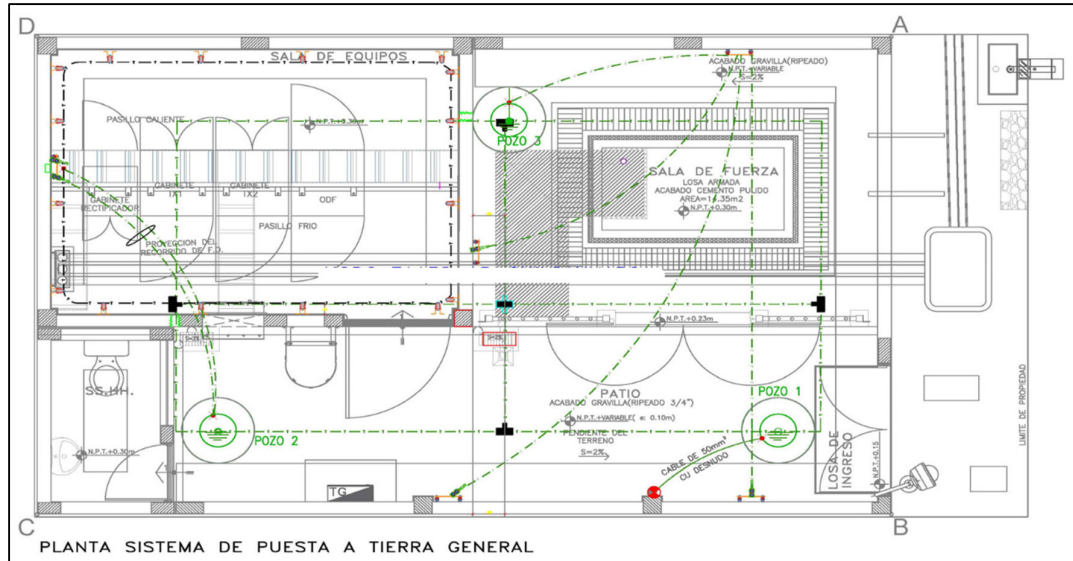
Plano de Planta del Sistema Puesta a Tierra
